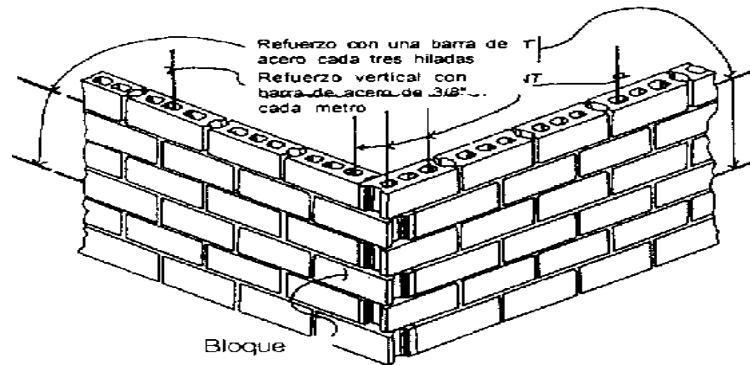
Esquema de muro portante o muro estructuras diseñados para soportar cargas mucho mayores que los muros de mampostería tradicionales. Tomado de: http://comoconstruirtuvivienda.blogspot.com/2013_05_01_archive.html
